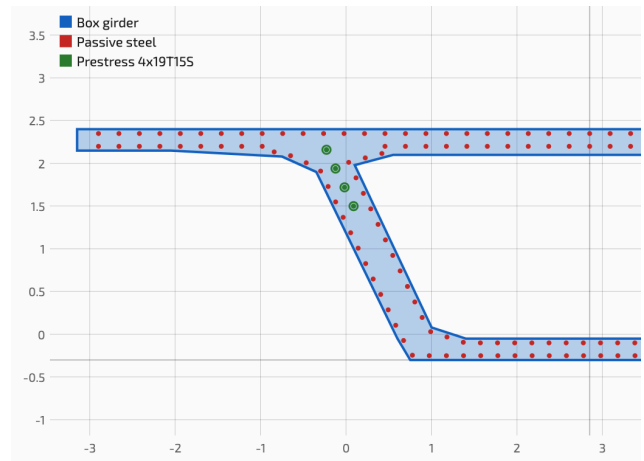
Voorbeelden van geavanceerde doorsneden in SectionPro.
